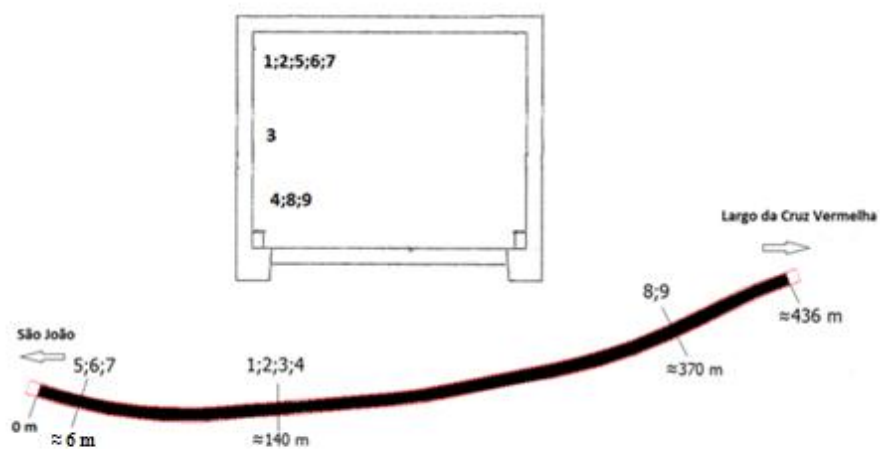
Localização em planta das carotes obtidas e os locais na secção transversal (Túnel da Cruz Vermelha)
